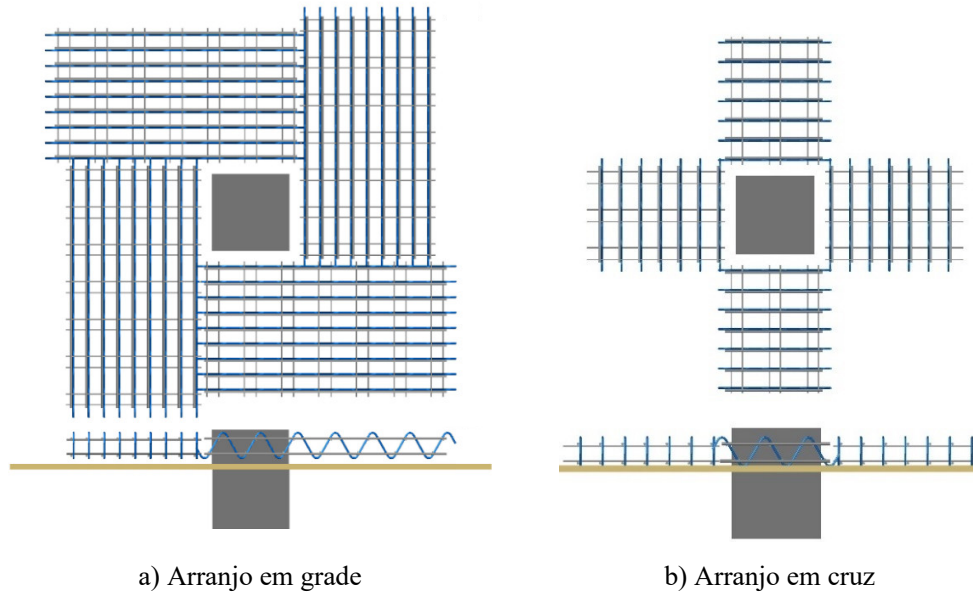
Processo de instalação dos estribos treliçados pré-fabricados.
